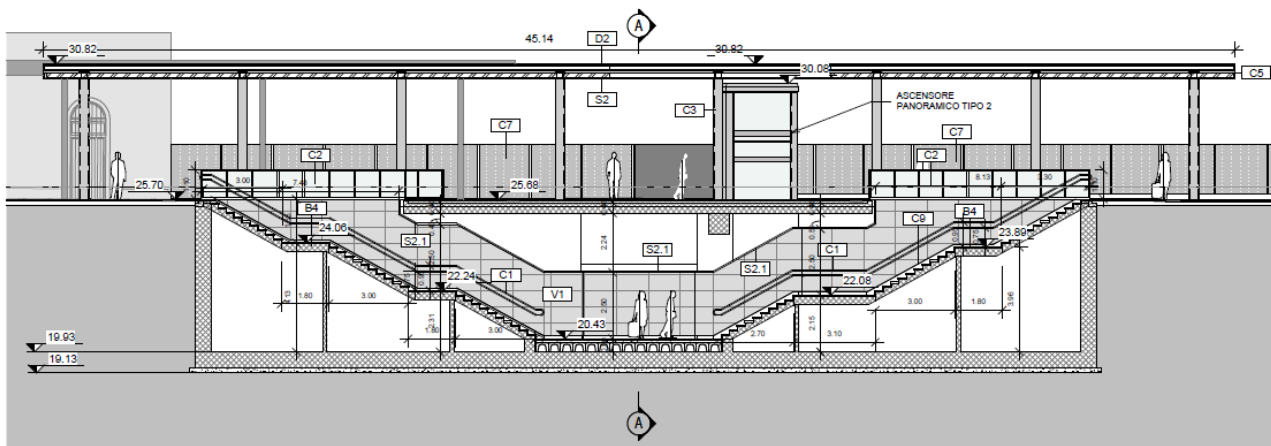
Sezione Trasversale sottopassaggio e scale marciapiede a isola
